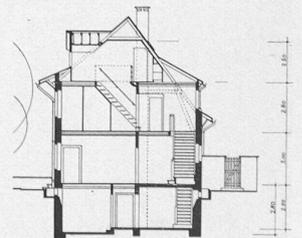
bis 11. Grundrisse und Schnitt, 1 : 400.
